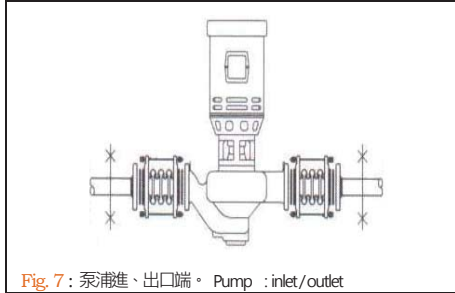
泵浦進、出口端。 Pump : inlet/outlet
